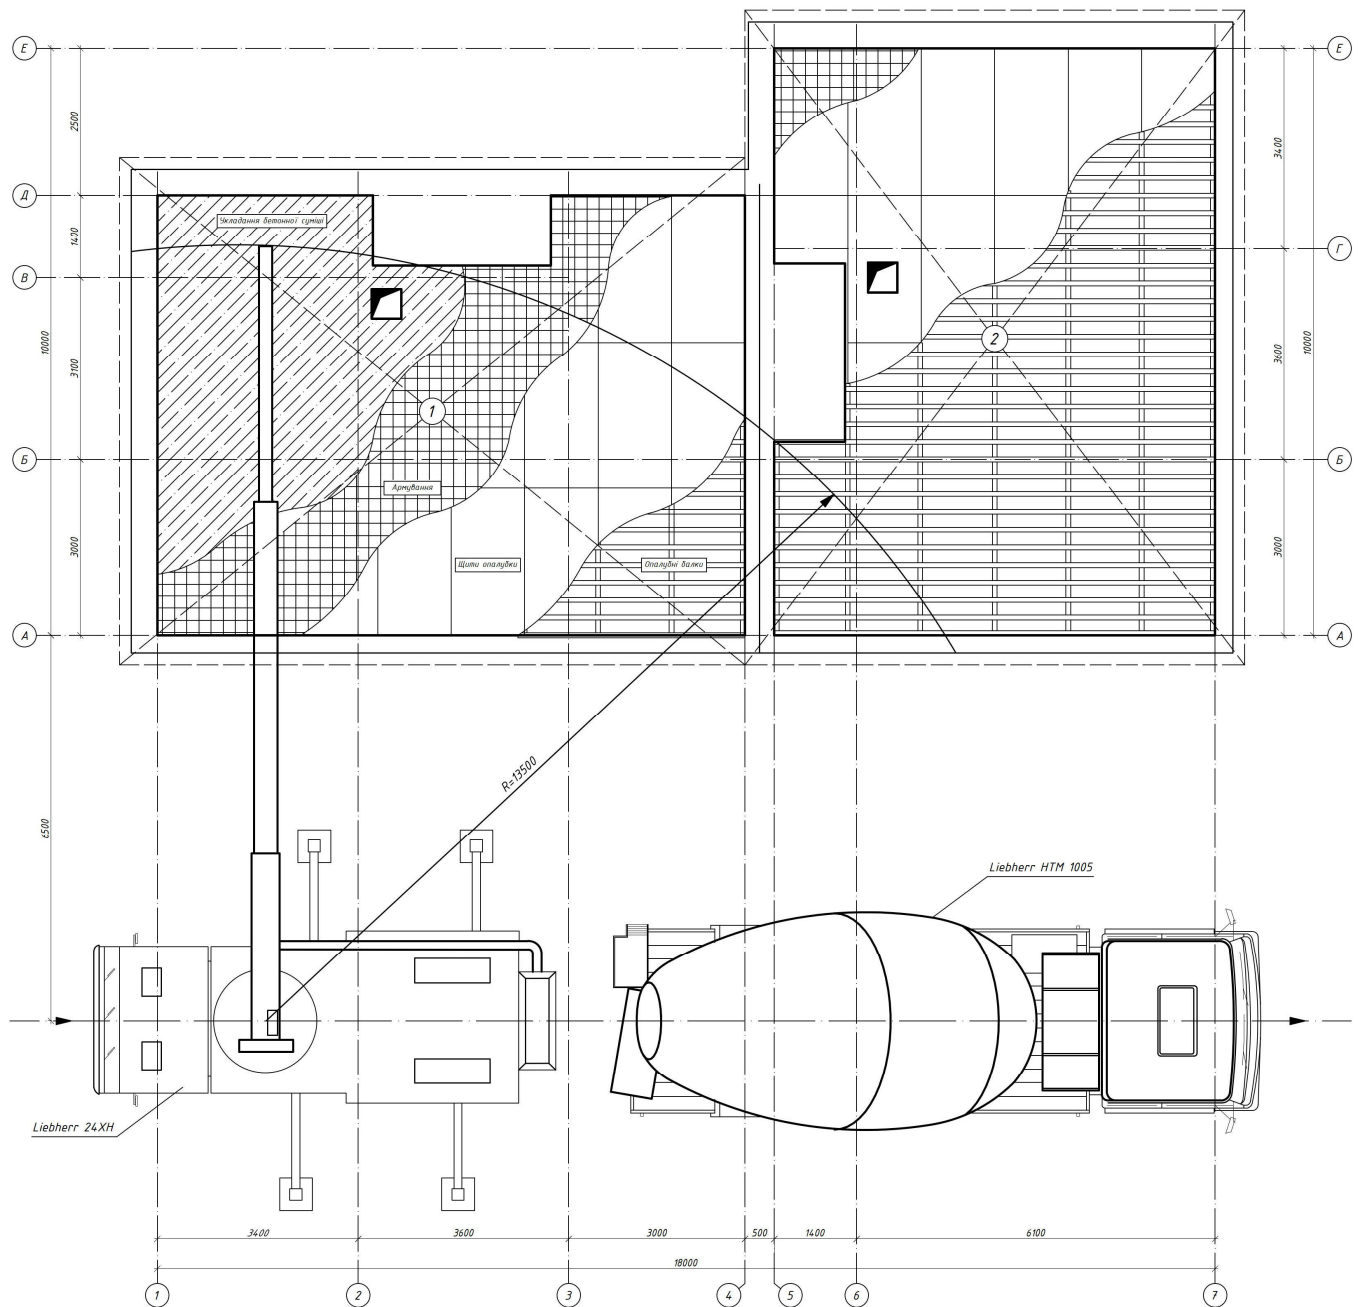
Схема виконання робіт з влаштування монолітного перекриття
